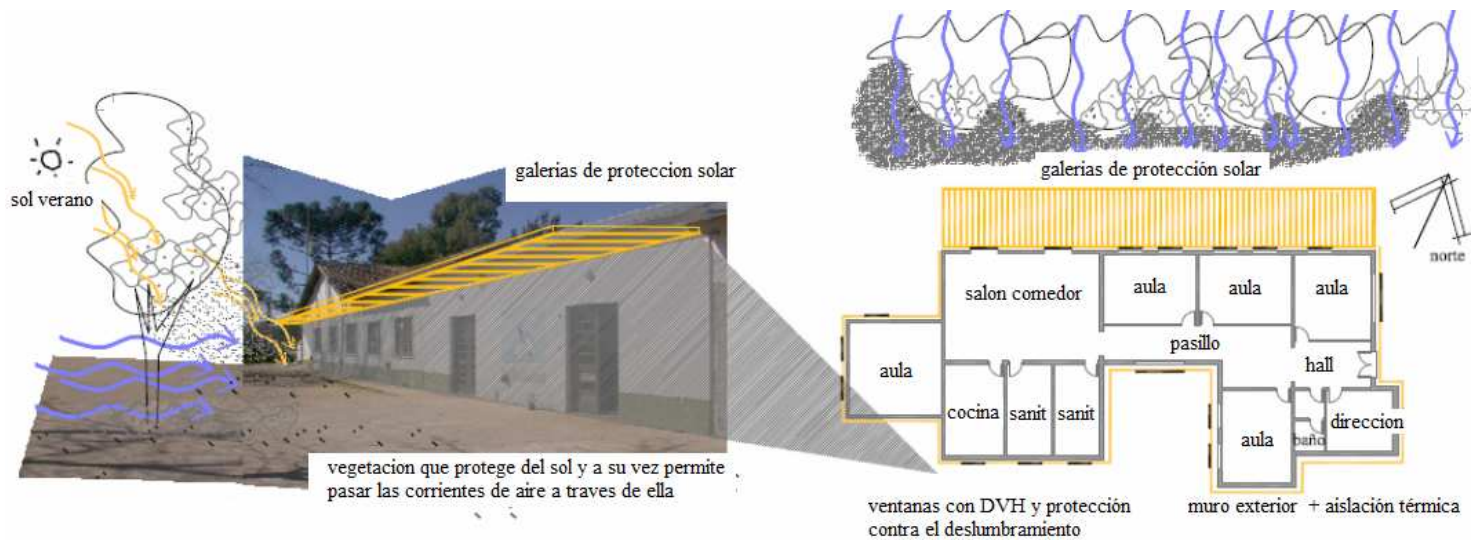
Fotomontaje de la fachada NO, la galería y la pantalla verde; y planta de la escuela con las modificaciones mencionadas.
